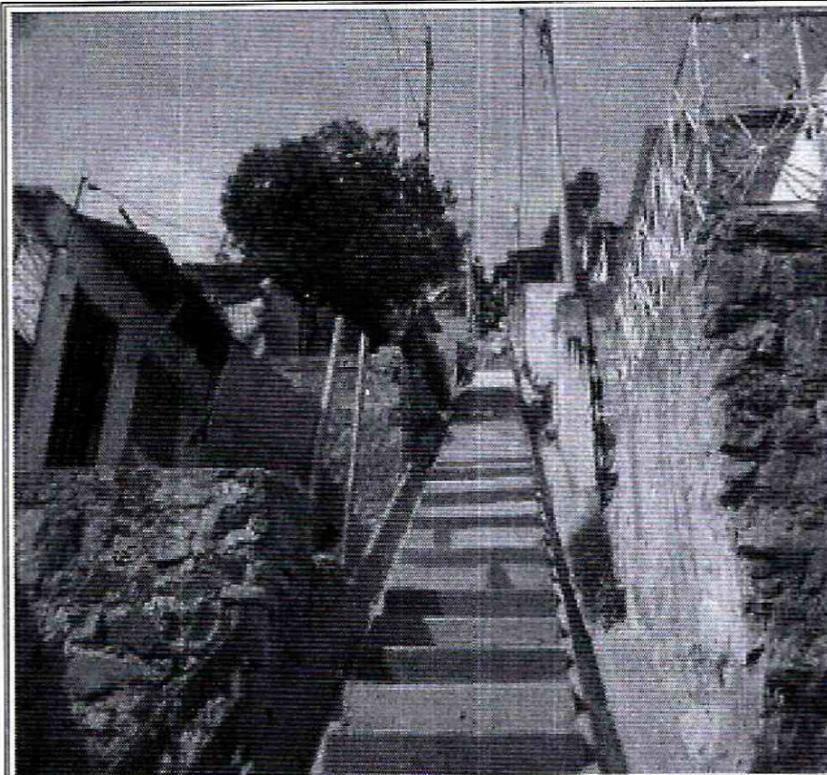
Via de acceso al predio de la Calle 71 A Sur No. 20 A - 61
